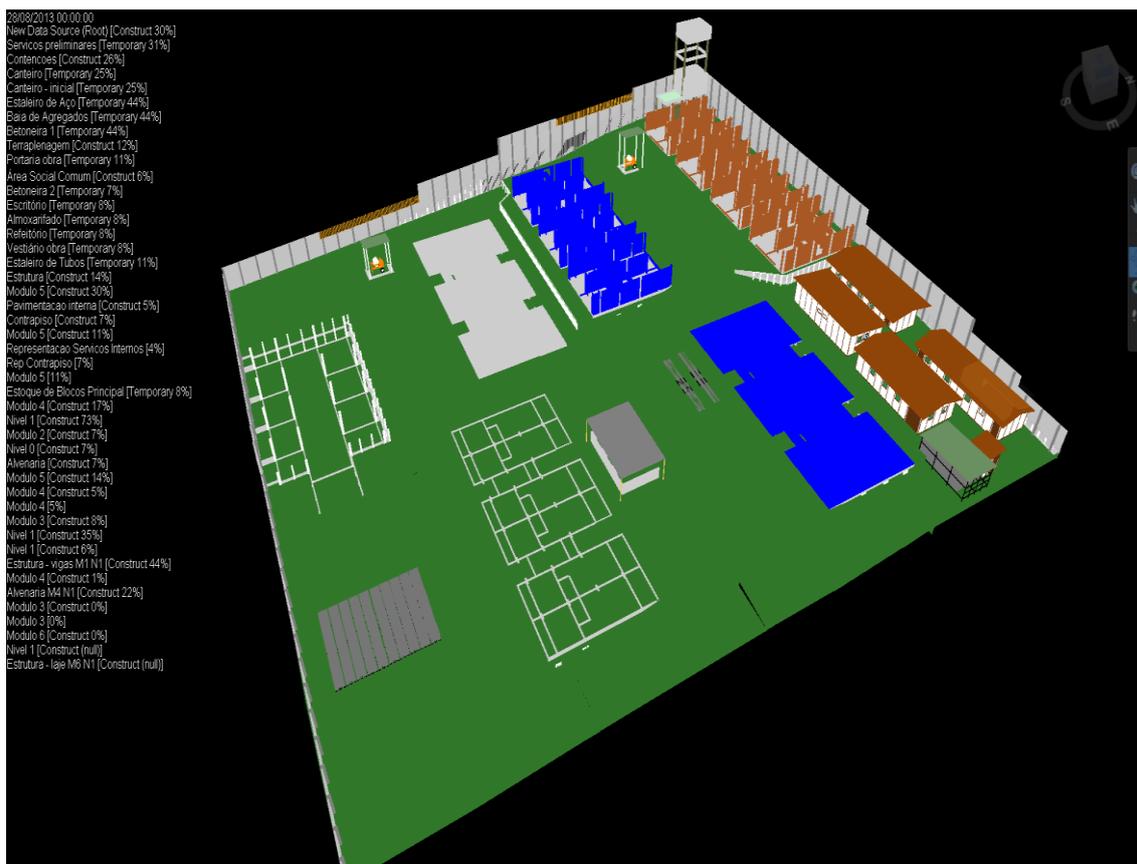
Planejamento em 28/08/13: estrutura, alvenaria e canteiro
